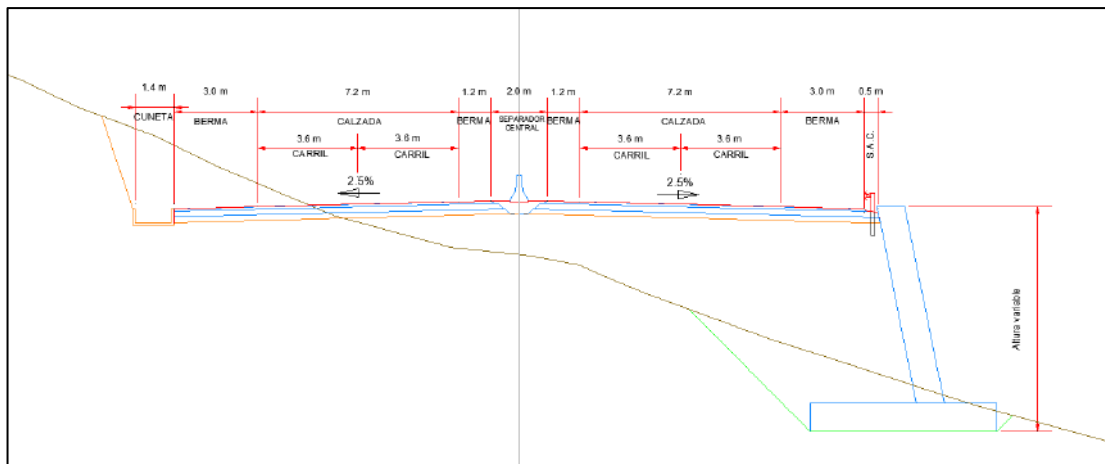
Sección típica en tangente a media ladera con muro de concreto para la Alternativa 3.
